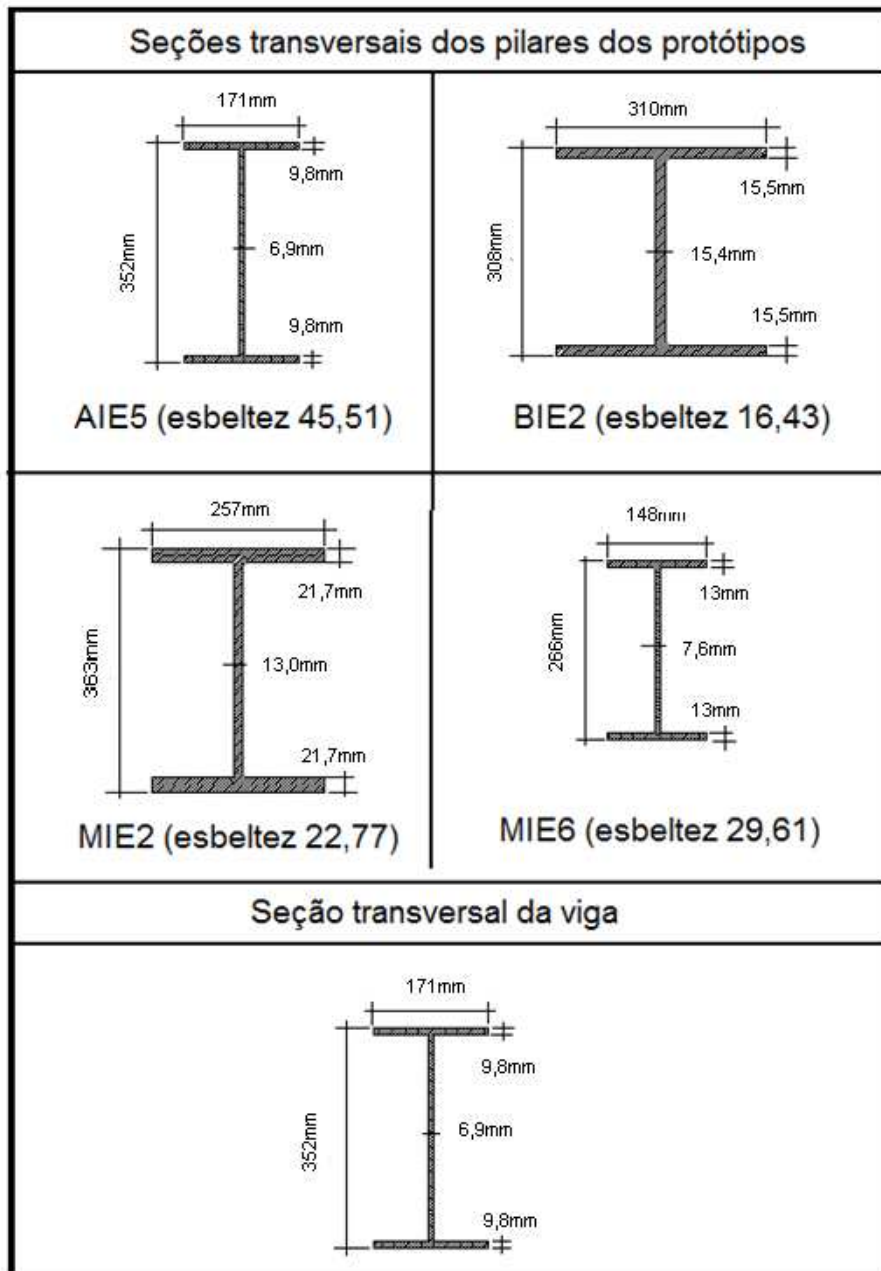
Seções transversais dos pilares e da viga dos protótipos ensaiados
